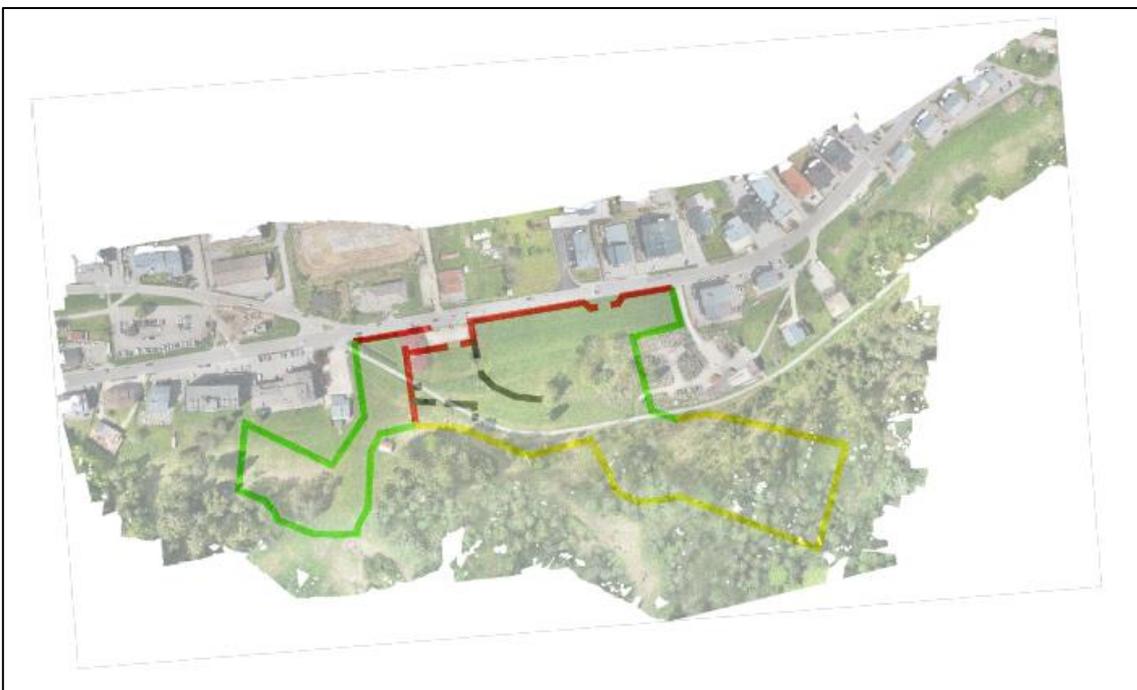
Recinzioni di cantiere - cantiere Ovest
